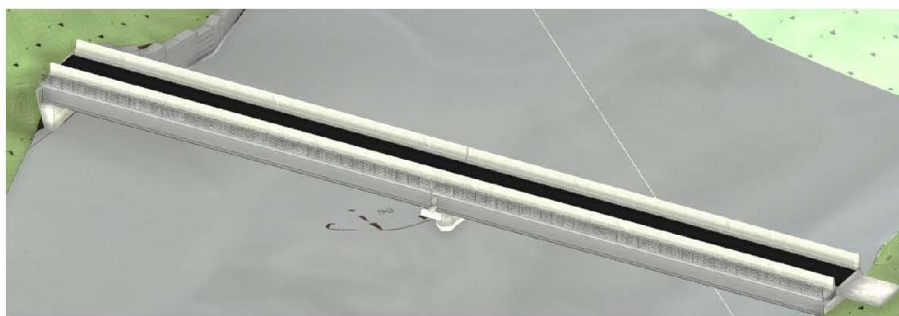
VISTA EM PERSPECTIVA 3D DA PONTE SOBRAGI
